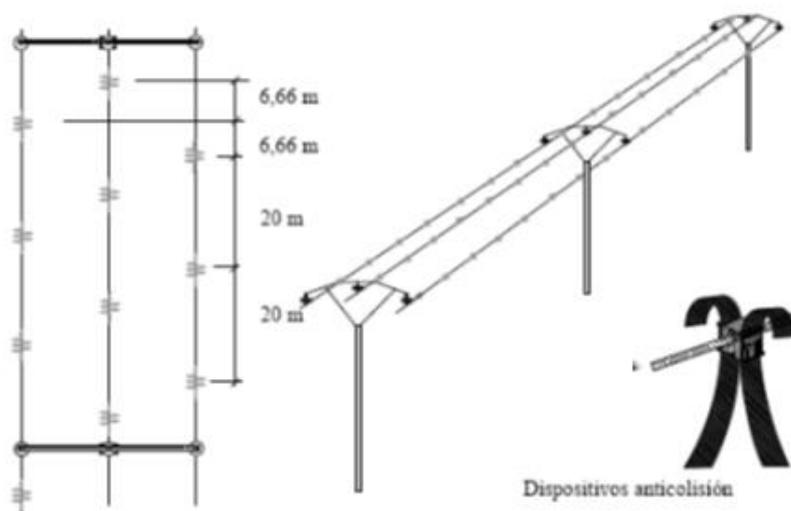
Dispositivos salvapájaros para prevenir la colisión.
